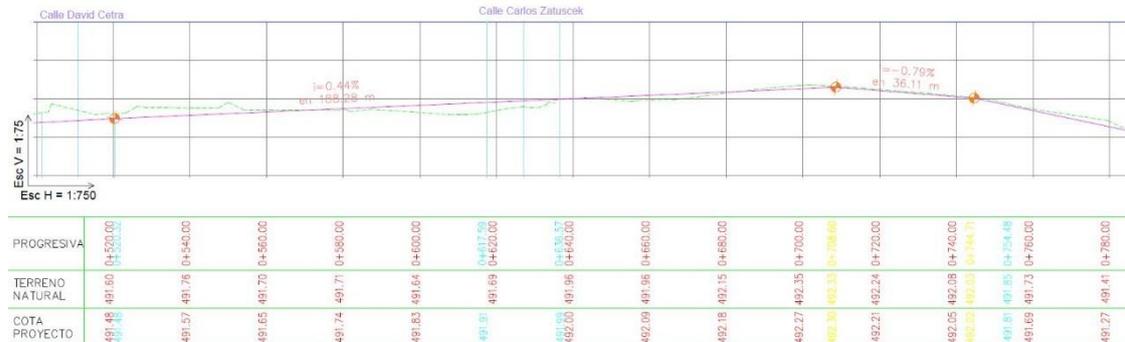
Altimetría del tramo trabajado por el alumno.
